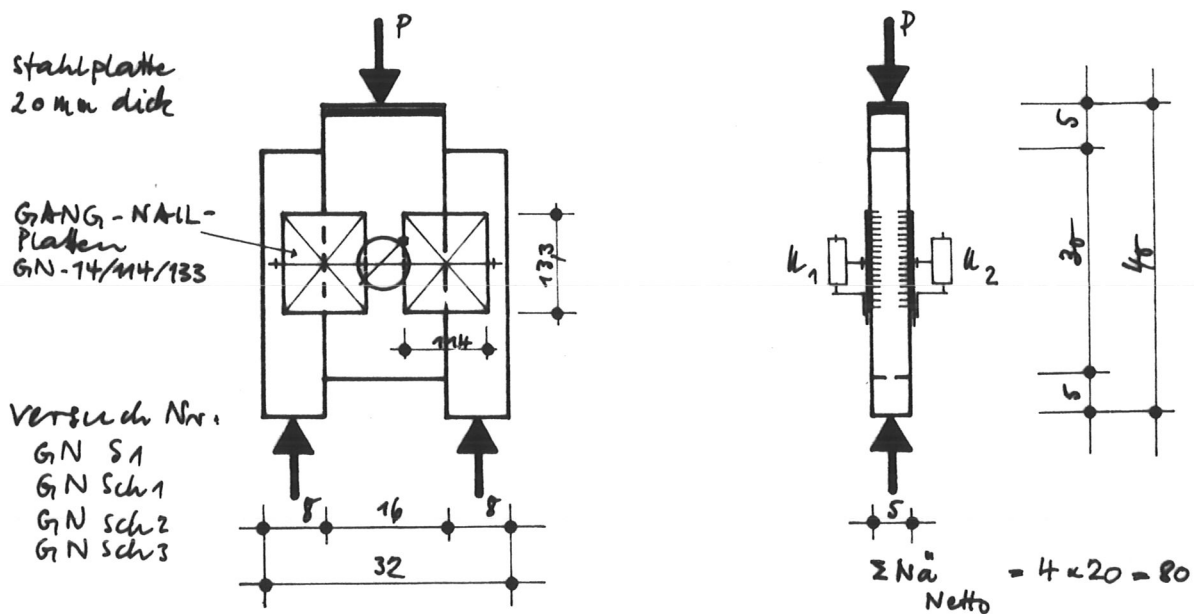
Probe Körper für Schwellversuche mit GANG-NAIL-Platten
